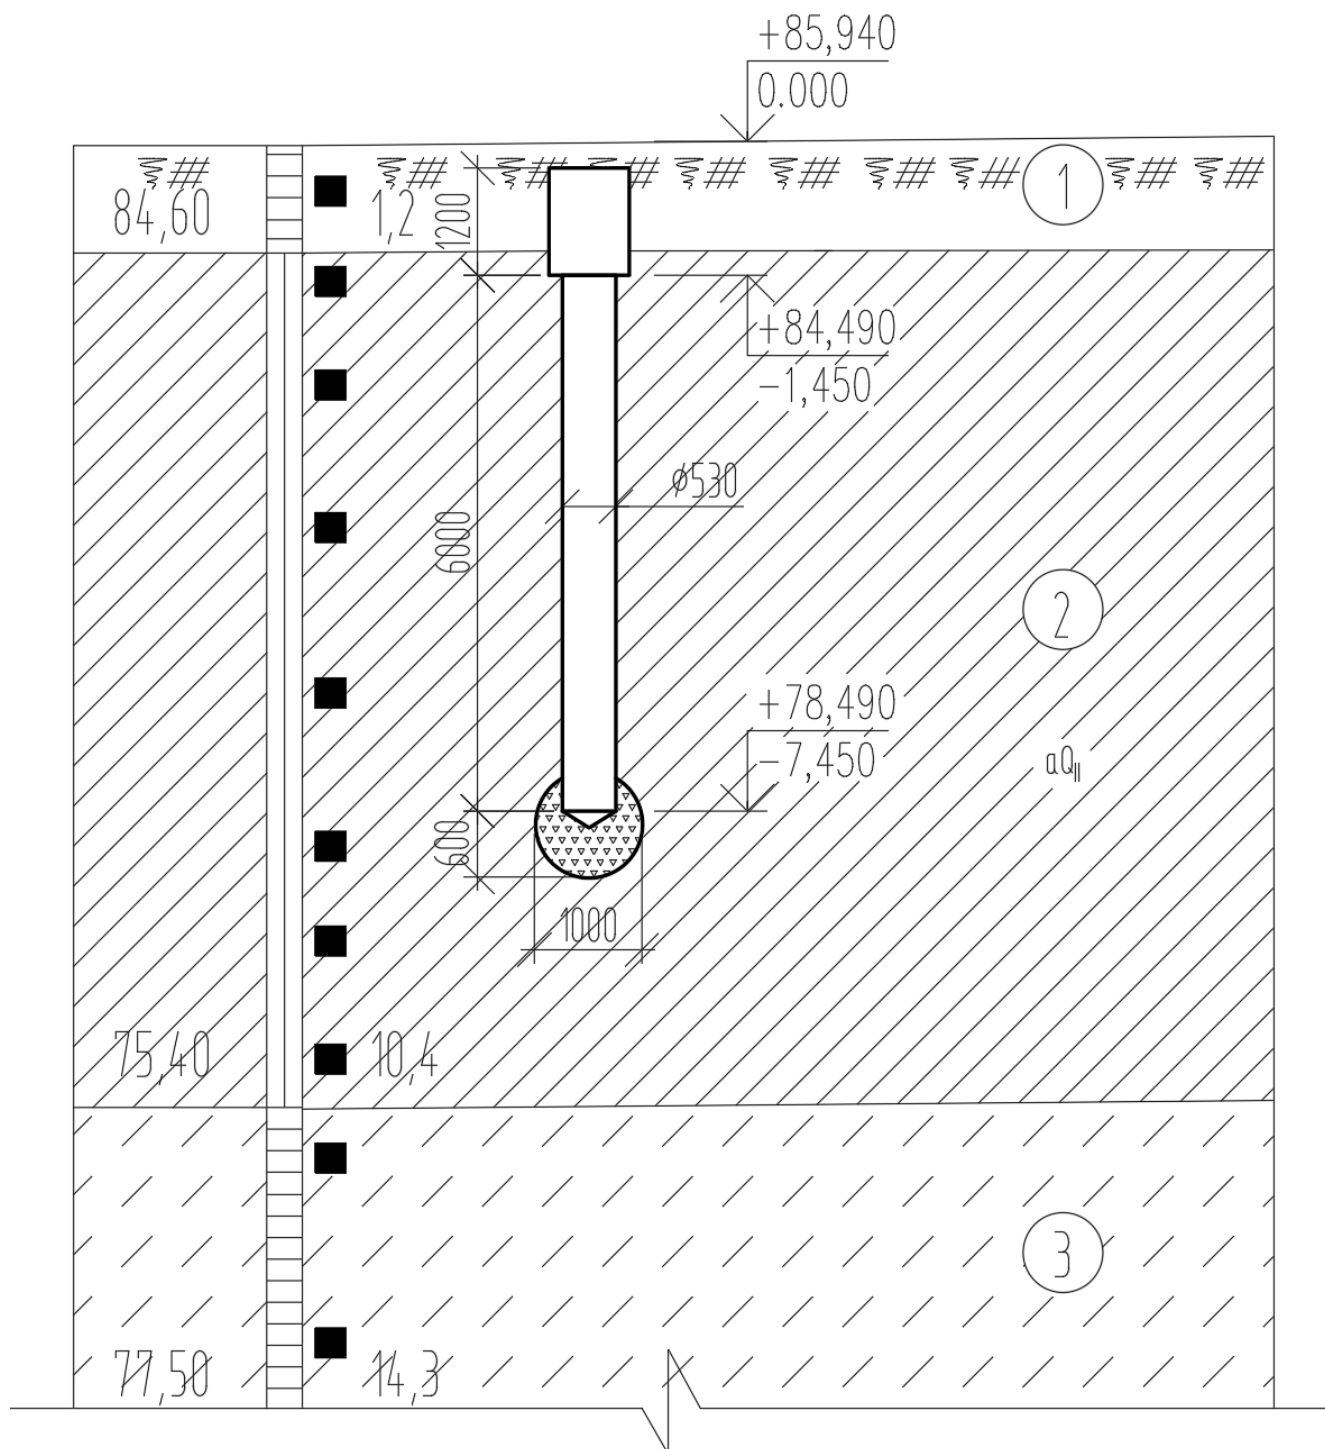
Фрагмент геологического разреза площадки строительства
